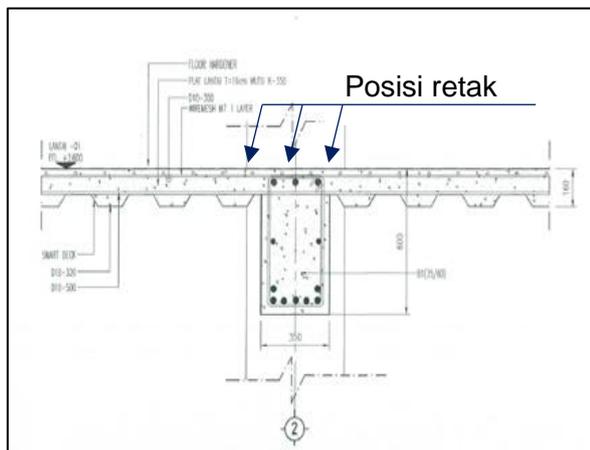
Retak slab beton lantai kendaraan pasca perbaikan
